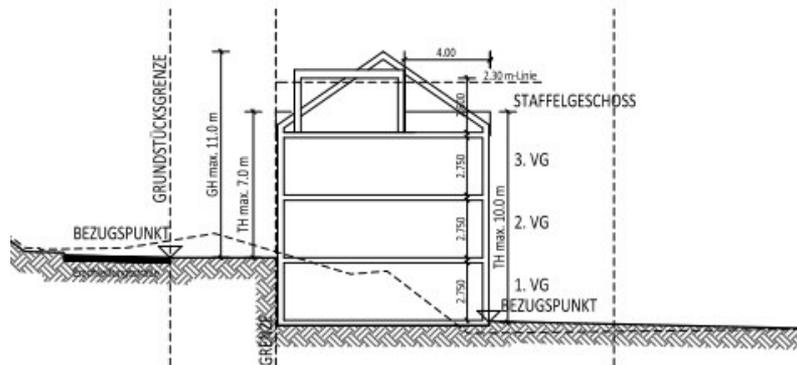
Systemschnitte der zulässigen Bebauung gemäß Bebauungsplan U2.6
